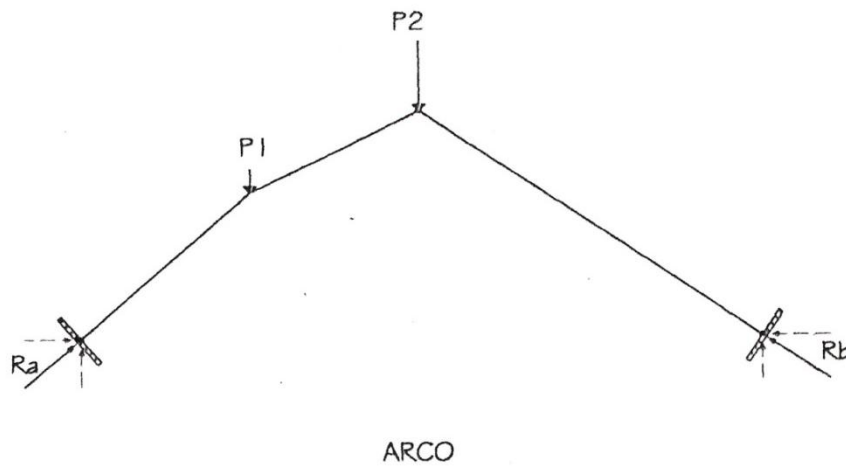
ESTRUCTURA TRABAJANDO A COMPRESION
